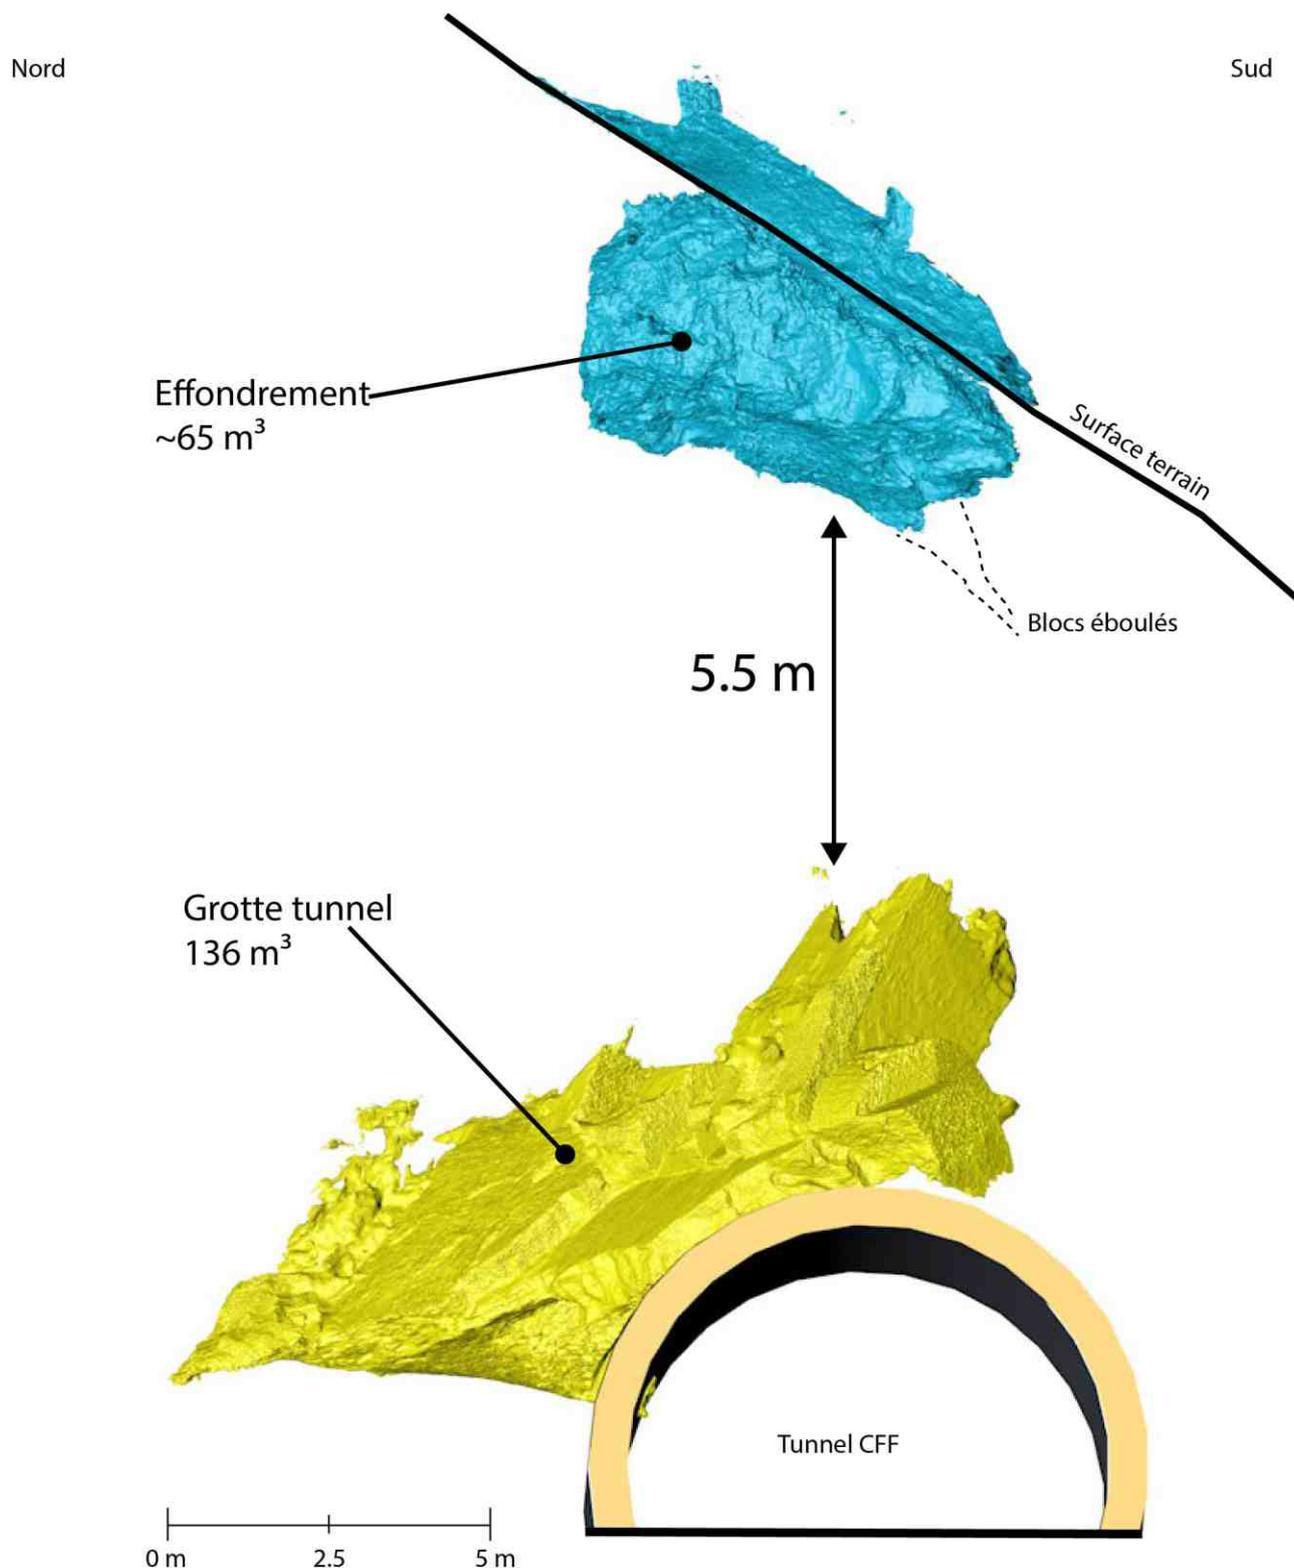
Coupe verticale perpendiculaire à l'axe du tunnel avec situation de l'effondrement de surface et de la grotte du tunnel
